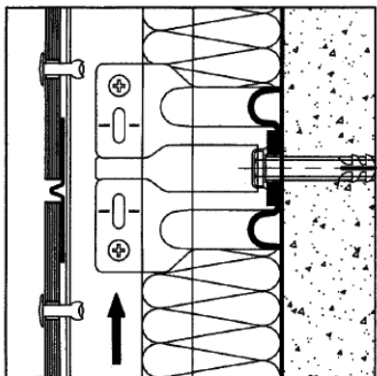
Afwerking onderzijde (verticale doorsnede)
